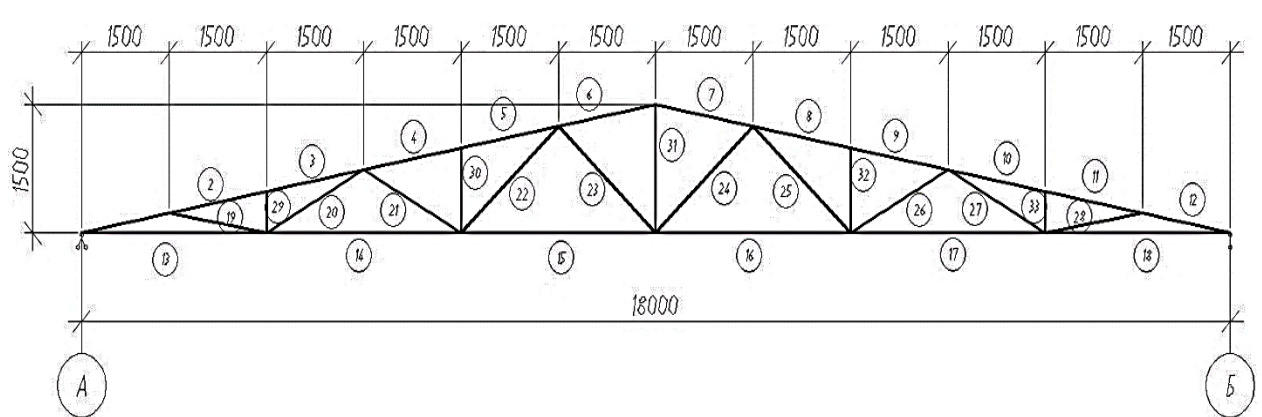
Расчетная схема фермы с номерами элементов
